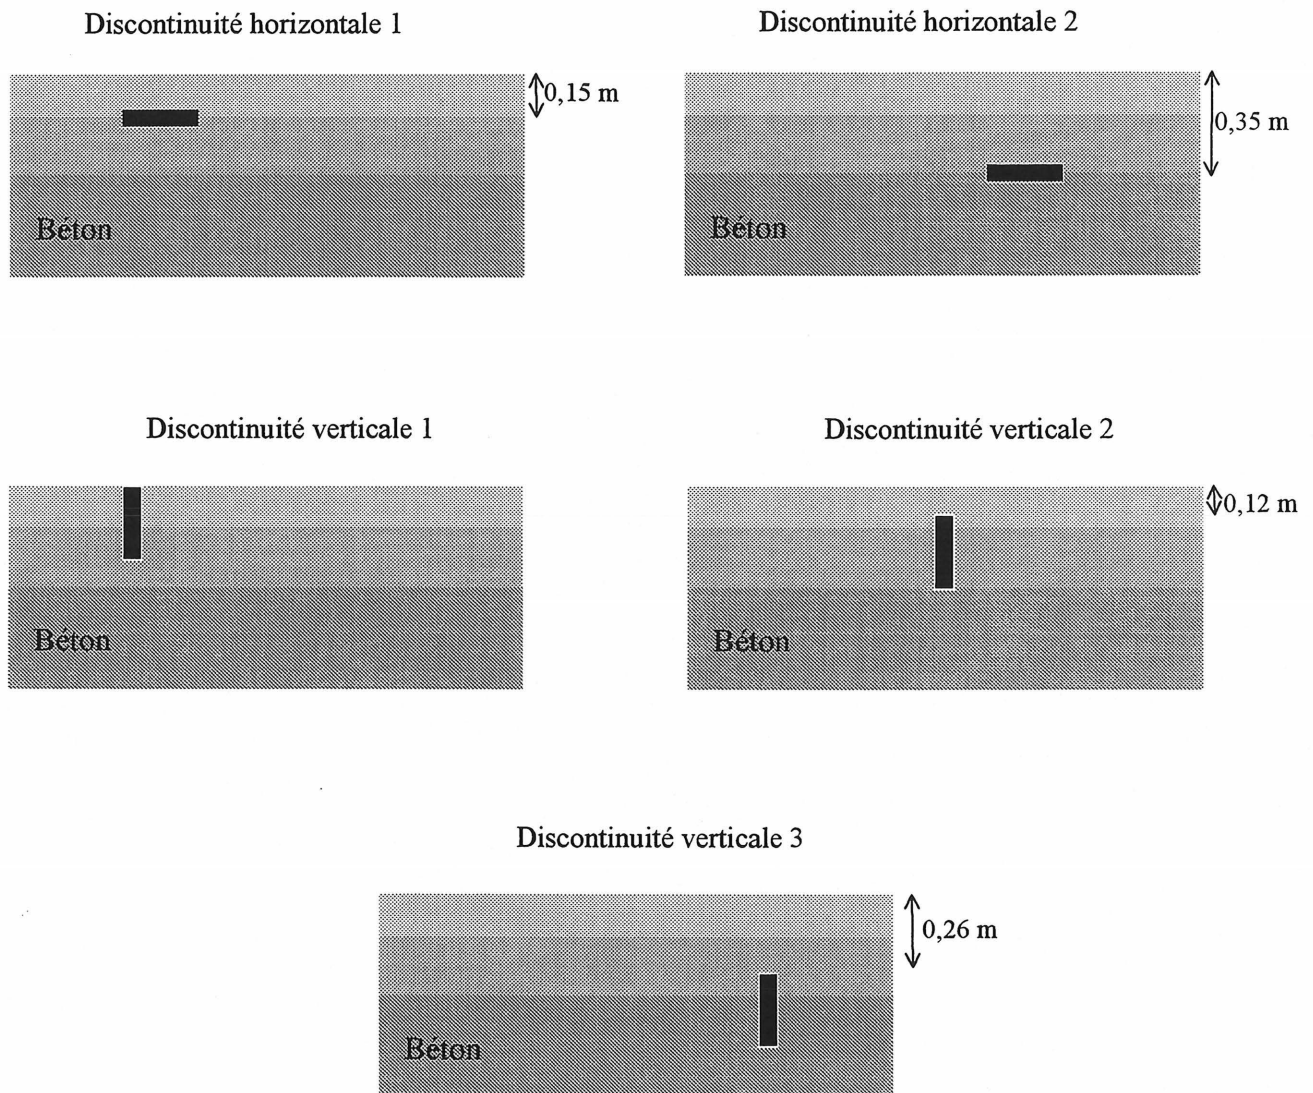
Disposition des discontinuités avant la mise en place du béton.
